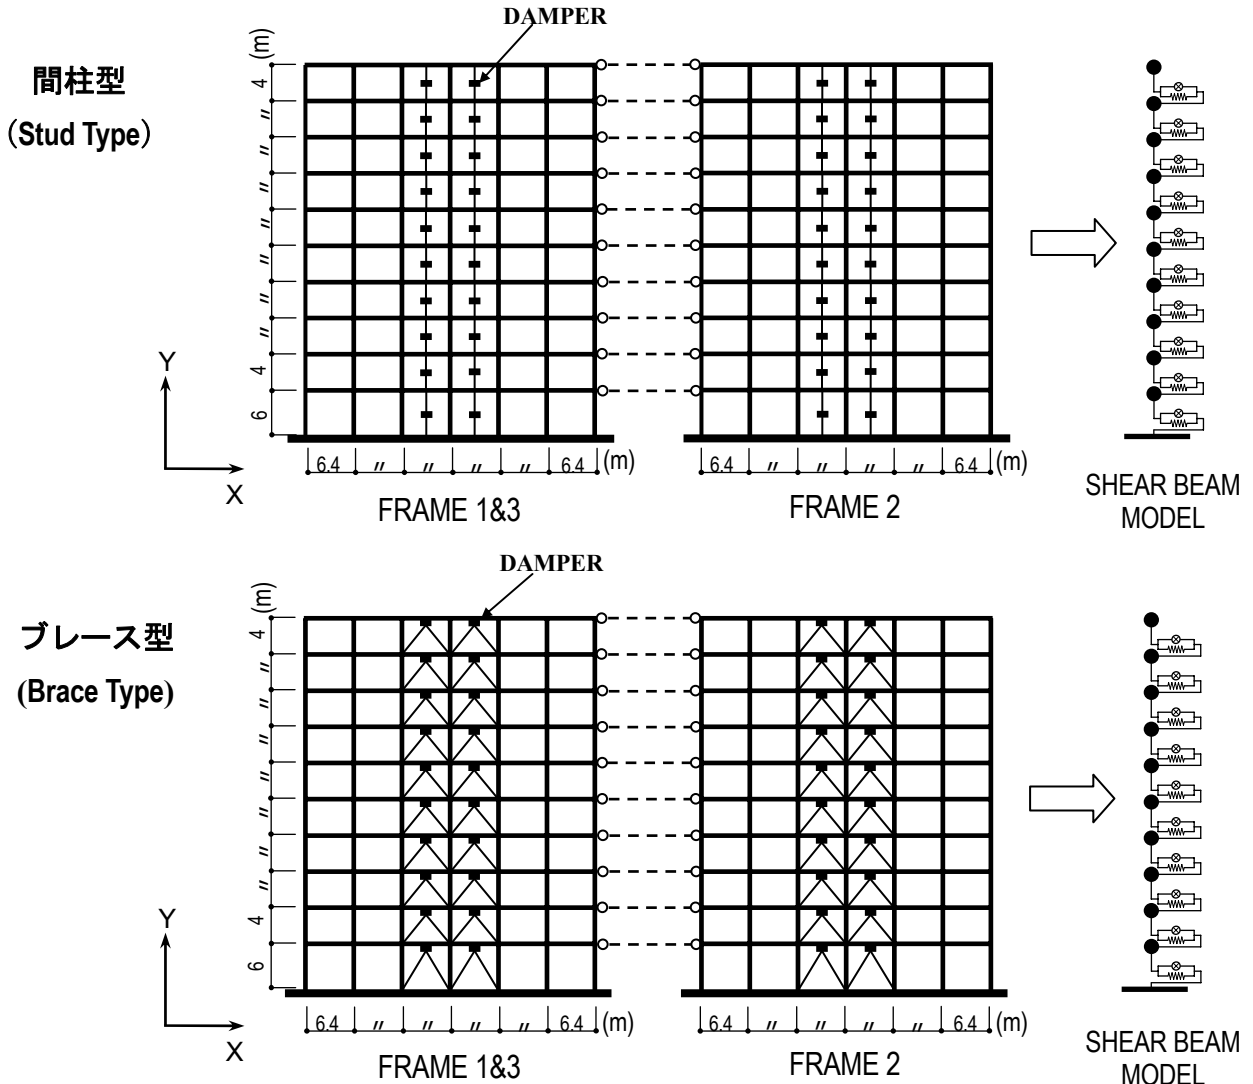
立面およびダンパーの配置 (Elevation and Damper Locations)
